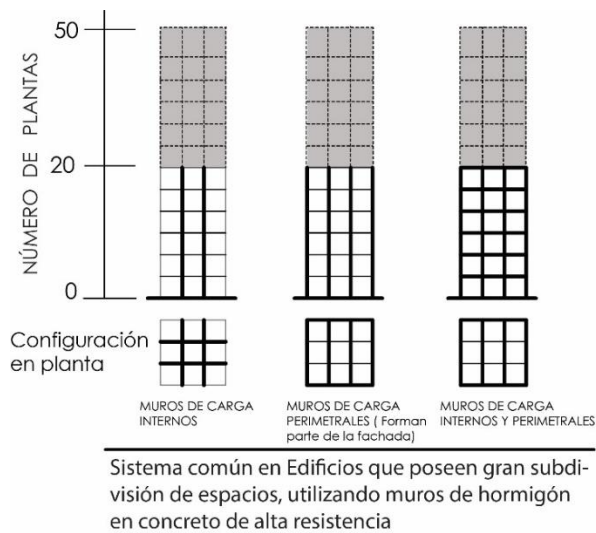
Diagrama Edificios con sistema de muros de carga. Fuente: Elaboración propia
